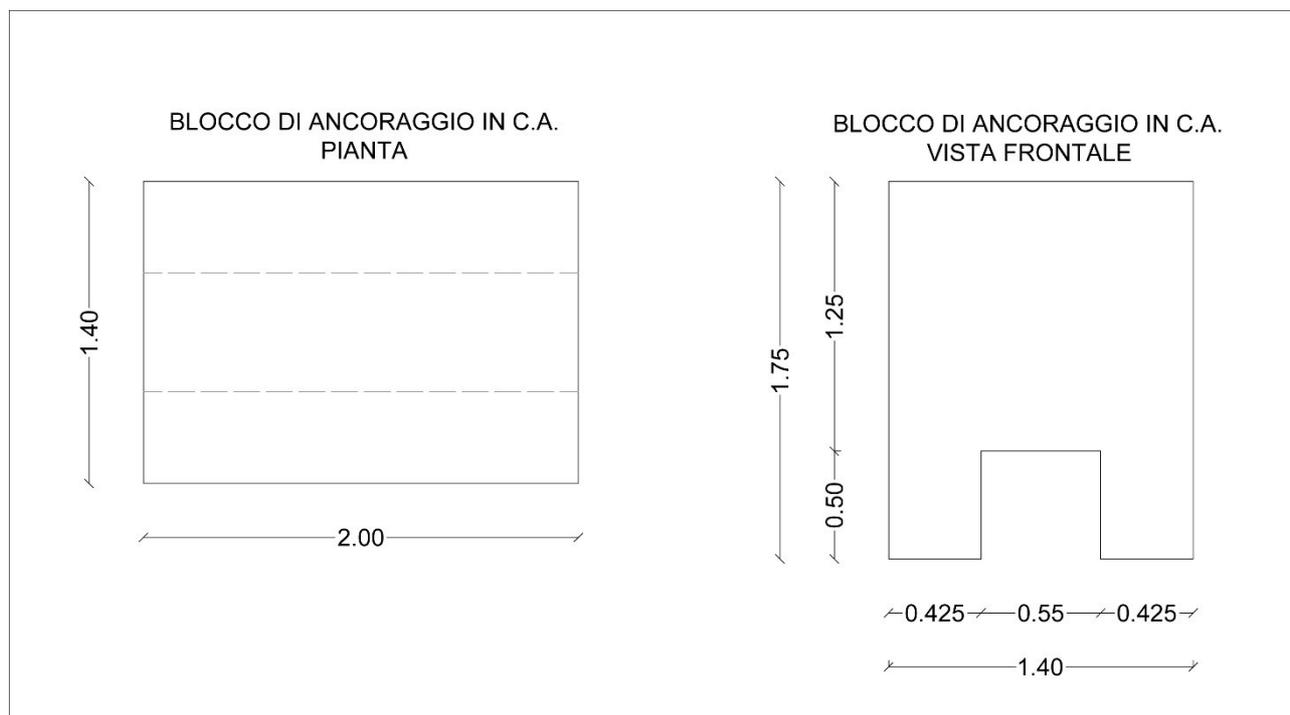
Particolare blocco di ancoraggio previsto dalla prog. 2716,79 m alla prog. 3180,74 m
